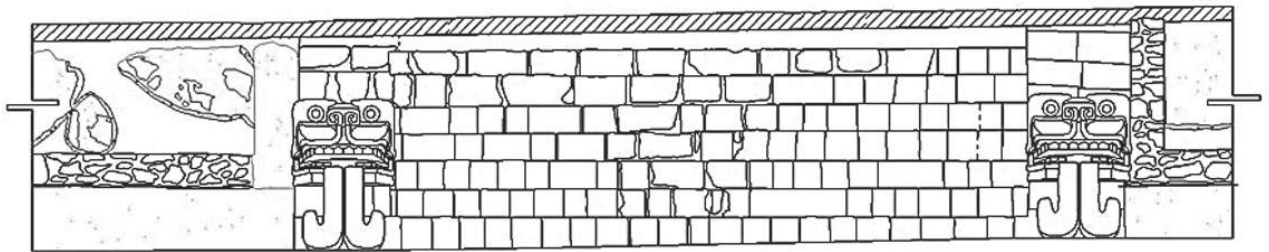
Fachada frontal de la escalinata de la primera etapa constructiva del basamento 40A. Archivo del departamento de Conservación y restauración, ZMAT, dibujó B. Blaisot.
